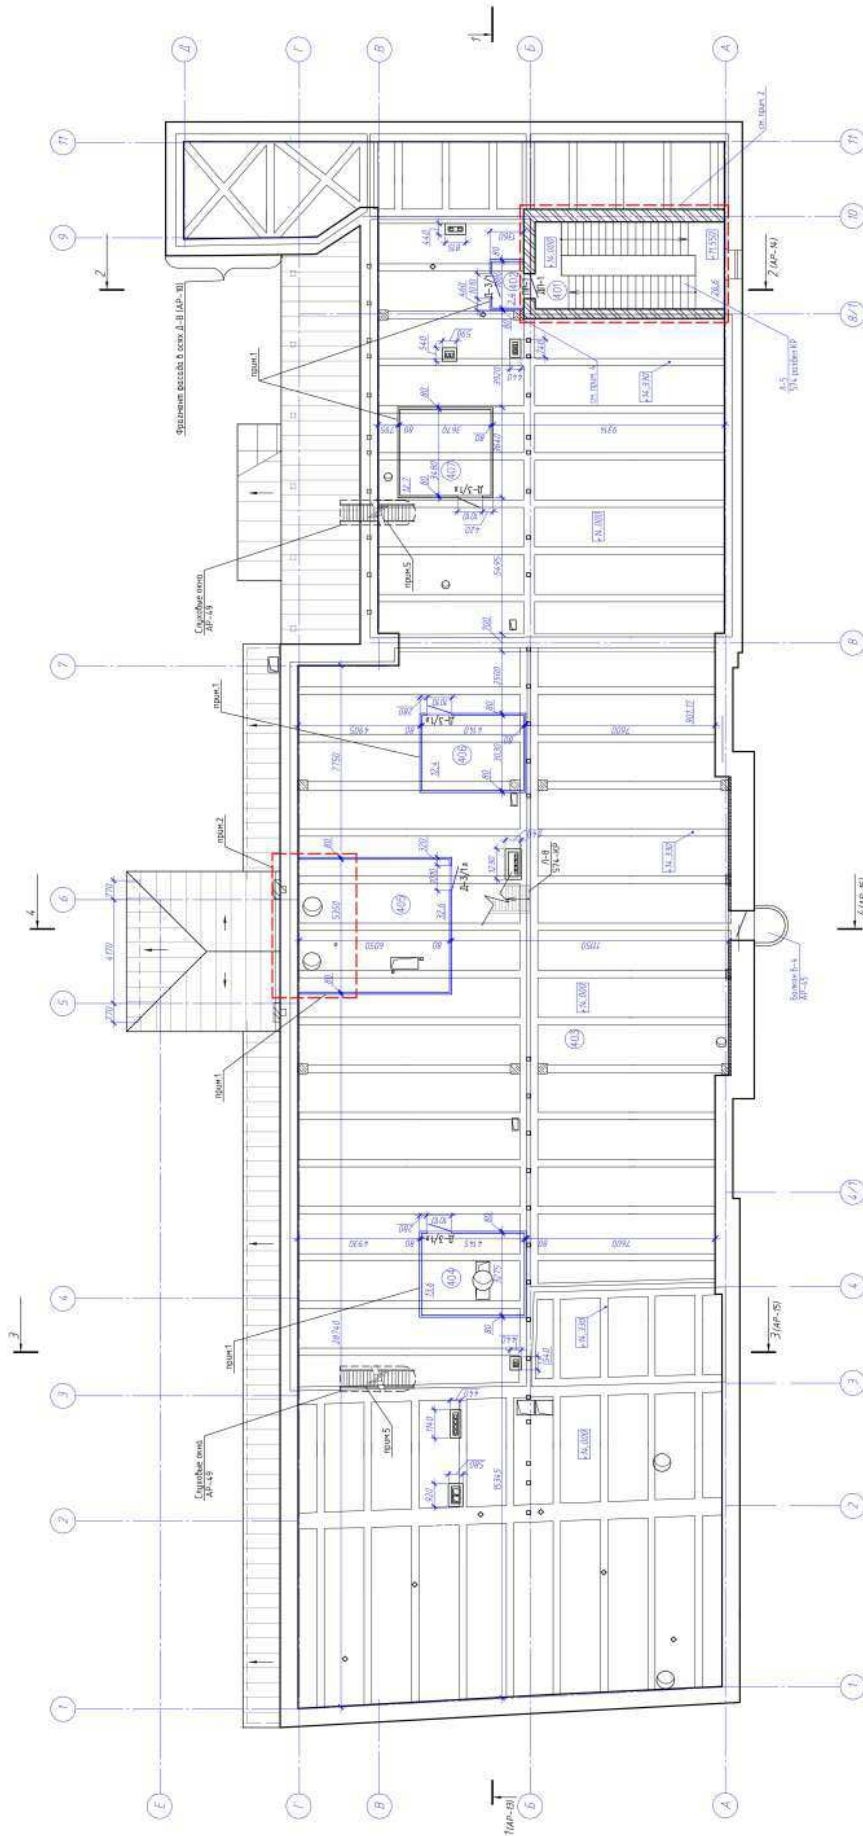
План реконструкции дома Вильнера разрез 1-1
